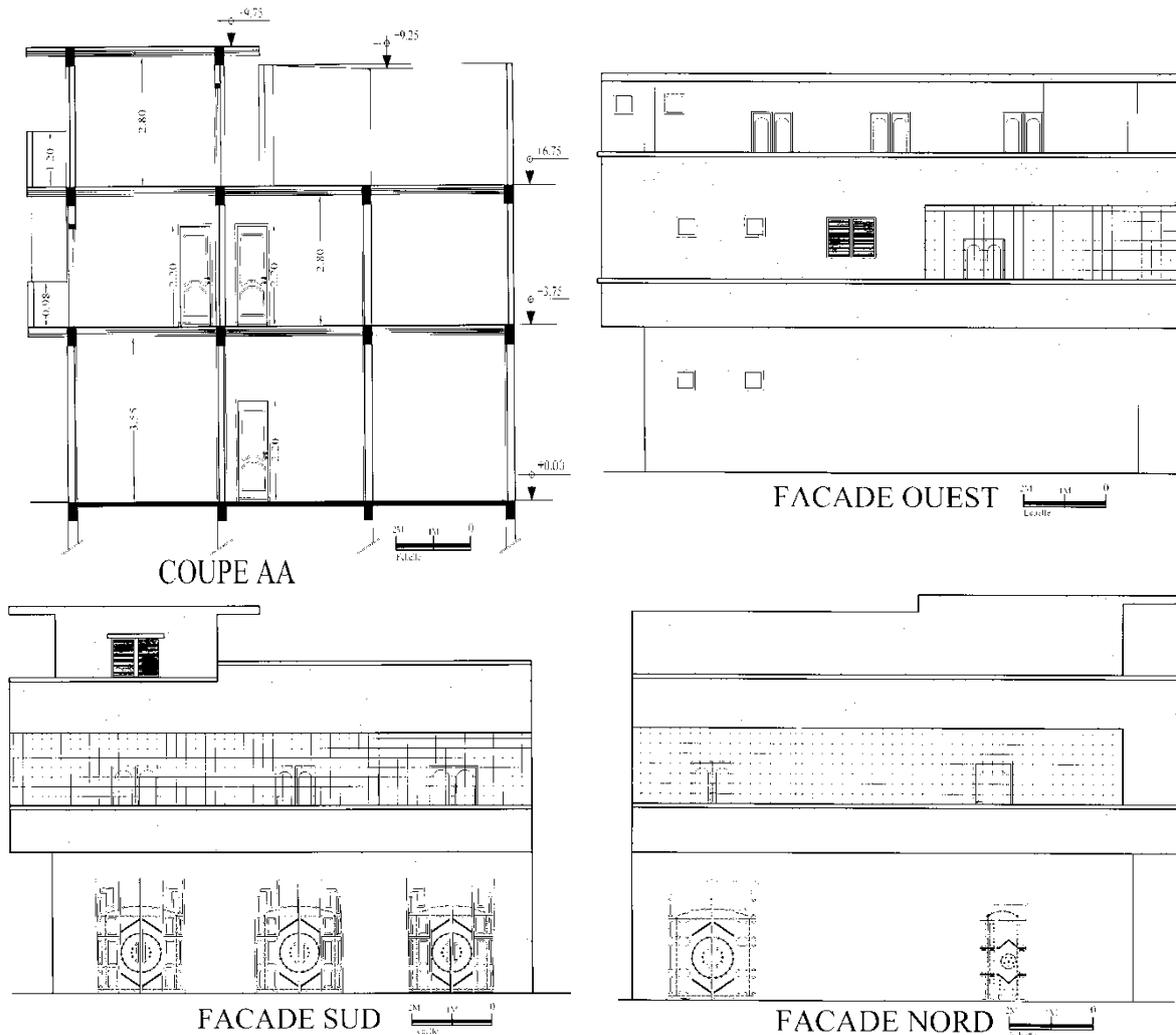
Coupe et Façades Contemporaine S'ouvre sur L'extérieur
